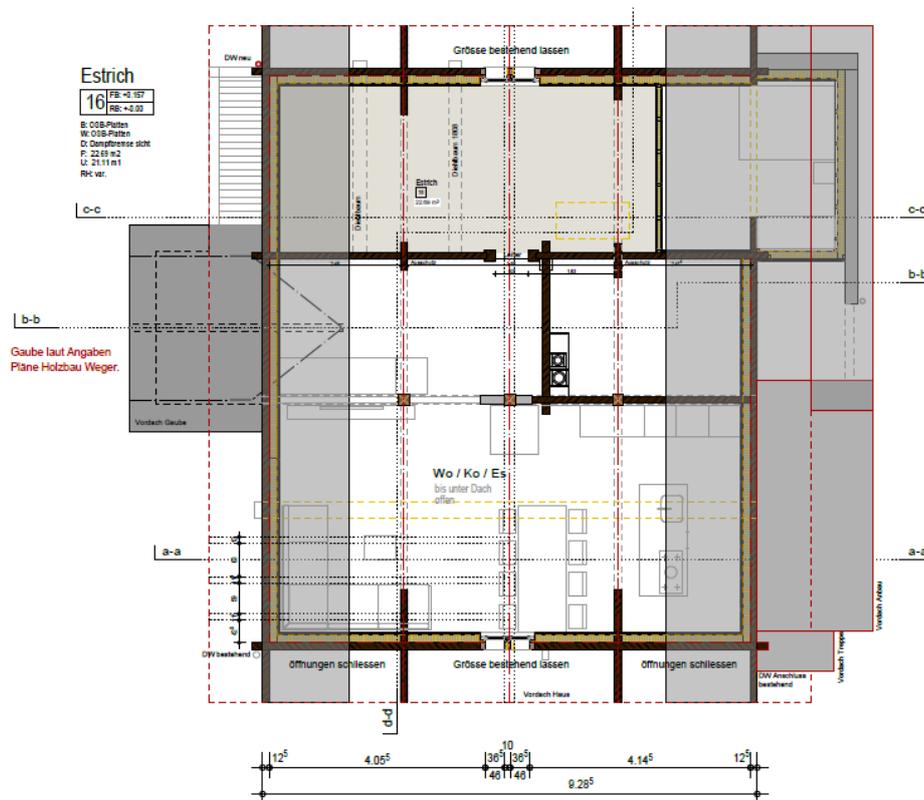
Unmassstäblicher Planausschnitt des Grundrisses DG – unbewohnt
